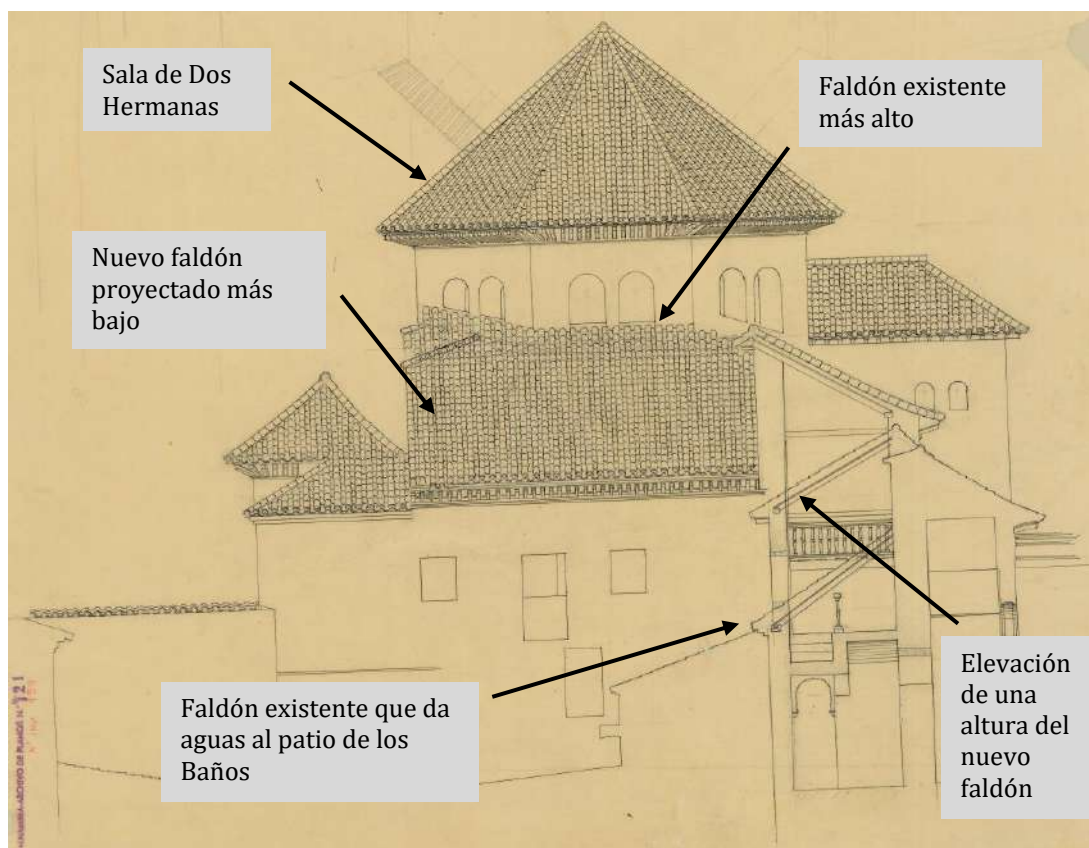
Plano en alzado de la Sala de Dos Hermanas. En el documento se yuxtaponen el estado previo y el propuesto. Torres Balbás, 1927. (APAG/ Colección de Planos/ P-000159).
